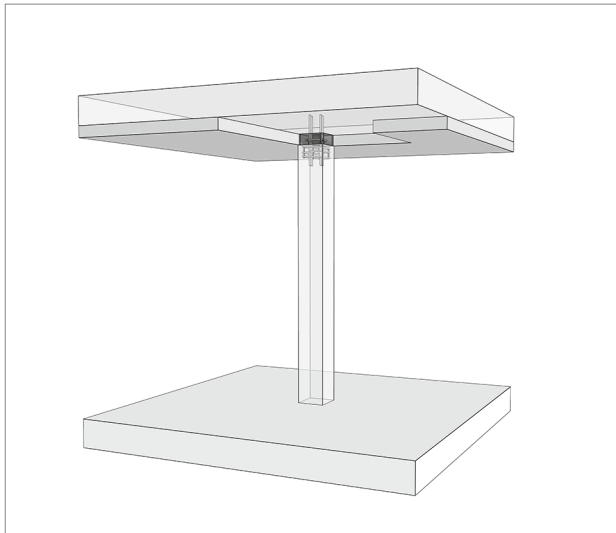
Anschlussdetail mit detailliertem Schöck Sconnex® Modell
